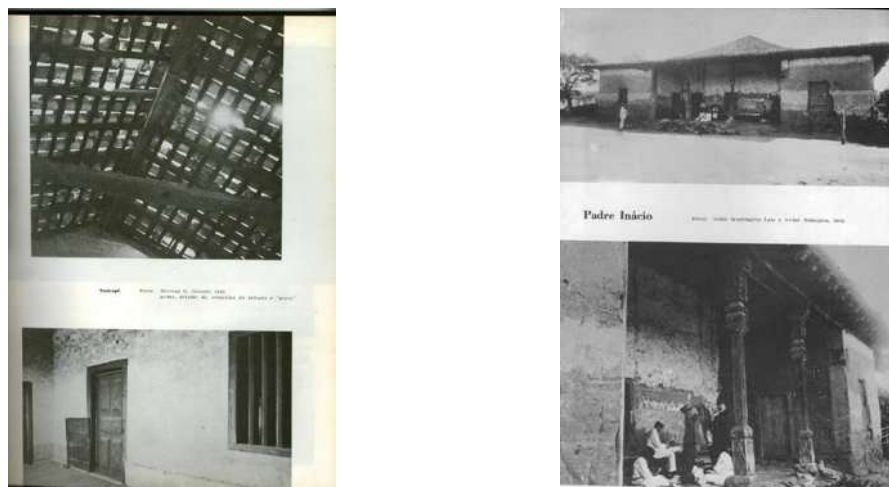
Casa colonial bandeirista estrutura da cobertura e vistas externas.
